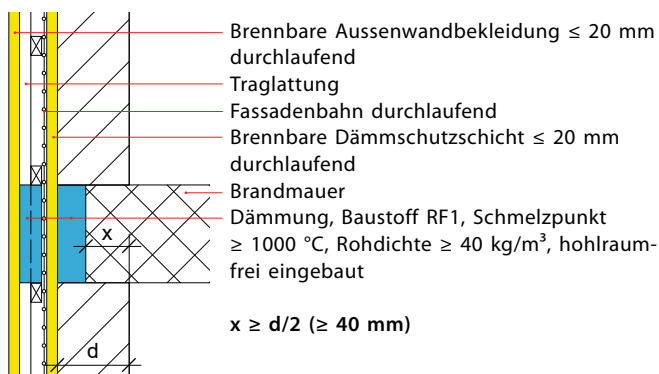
Brennbare Aussenwandbekleidung/Dämmschutzschicht ≤ 20 mm; Anschluss von Brandmauern an die Aussenwand (Skizze nach VKF)
